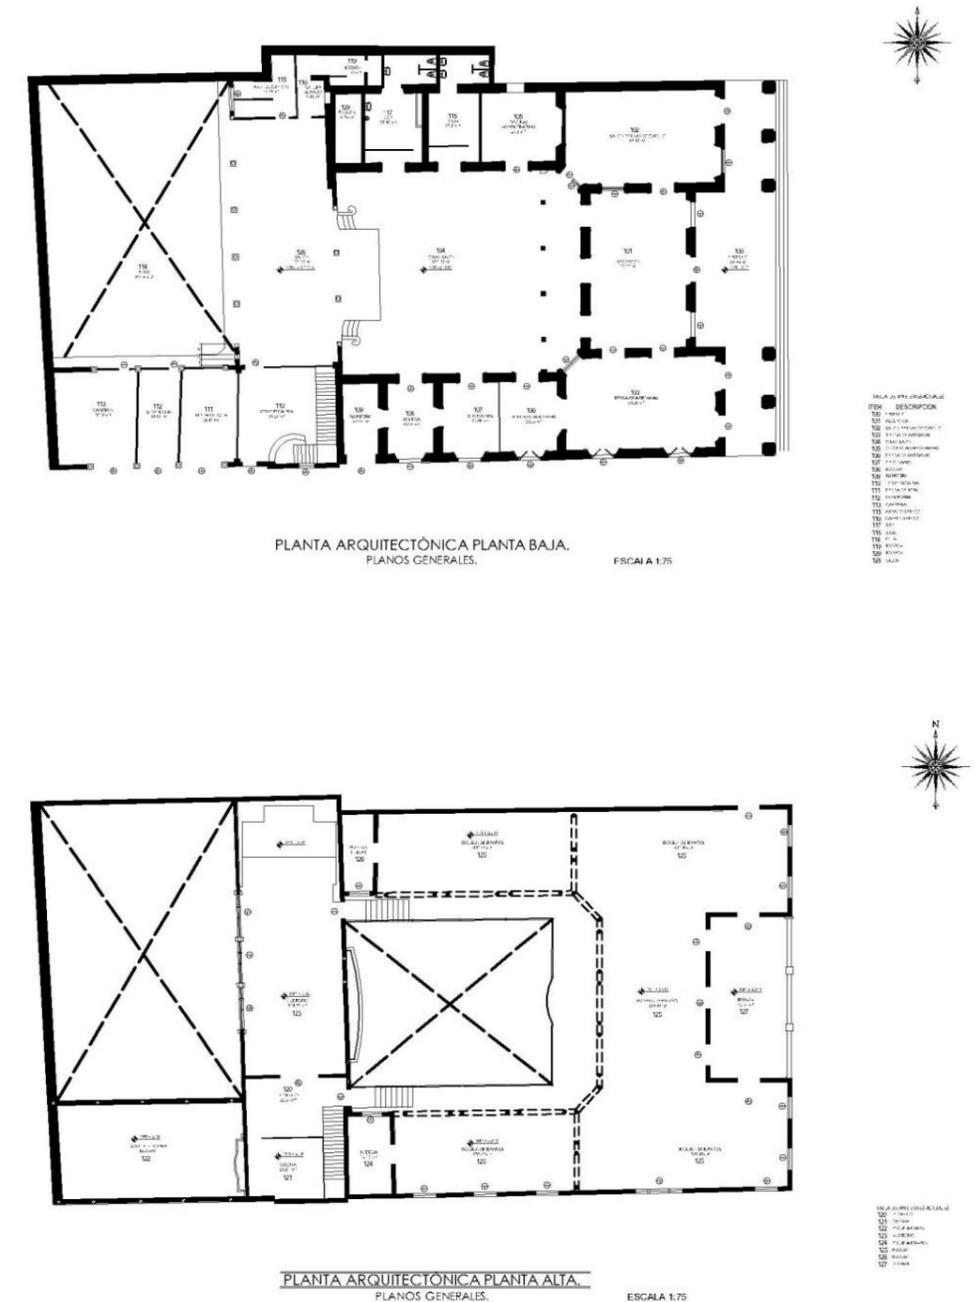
Planta arquitectónica de la Planta baja y Planta alta. Fuente: Autores
